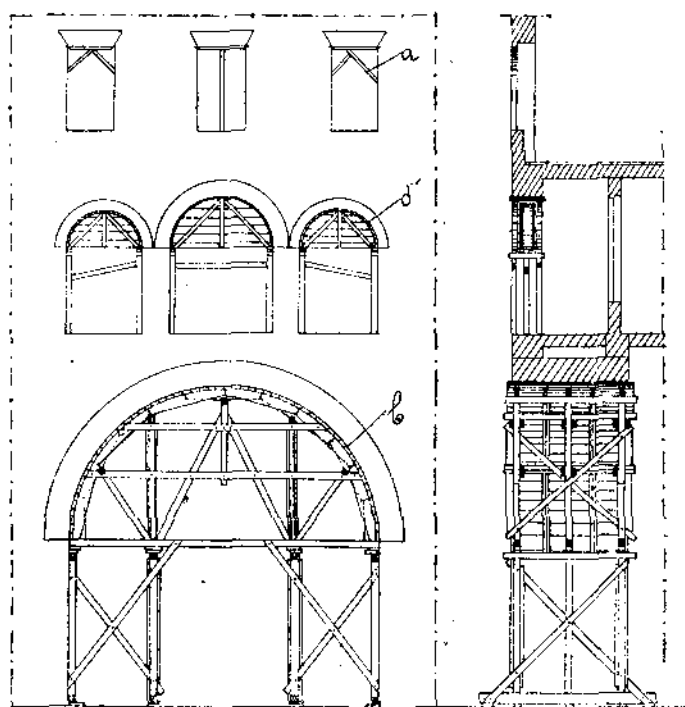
Шаблон Лидлера для кладки кирпичных стен:
